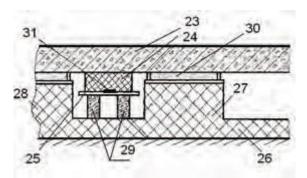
Схема виброизоляции железобетонной плиты в основании здания.
